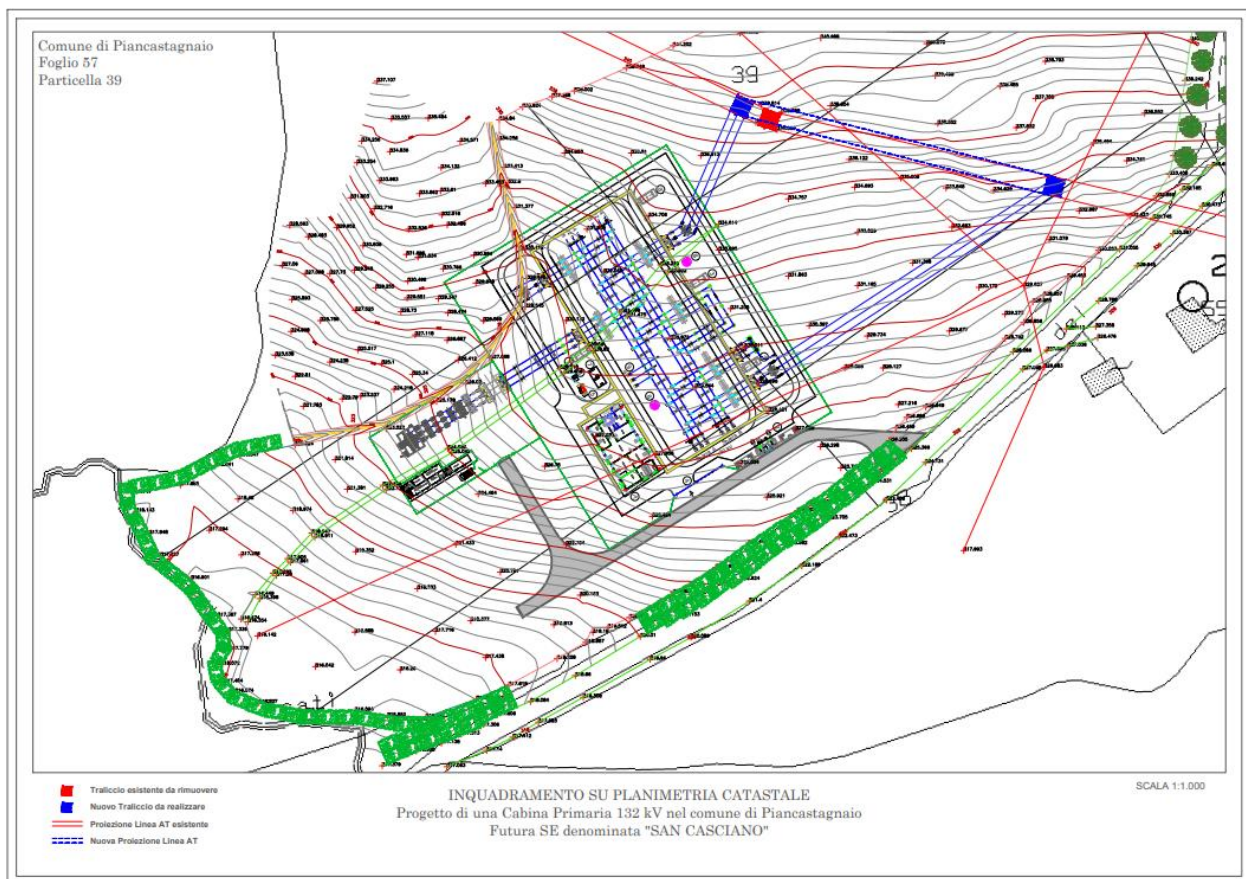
Planimetria nuova Stazione Elettrica San Casciano Dei Bagni su planimetria catastale.
